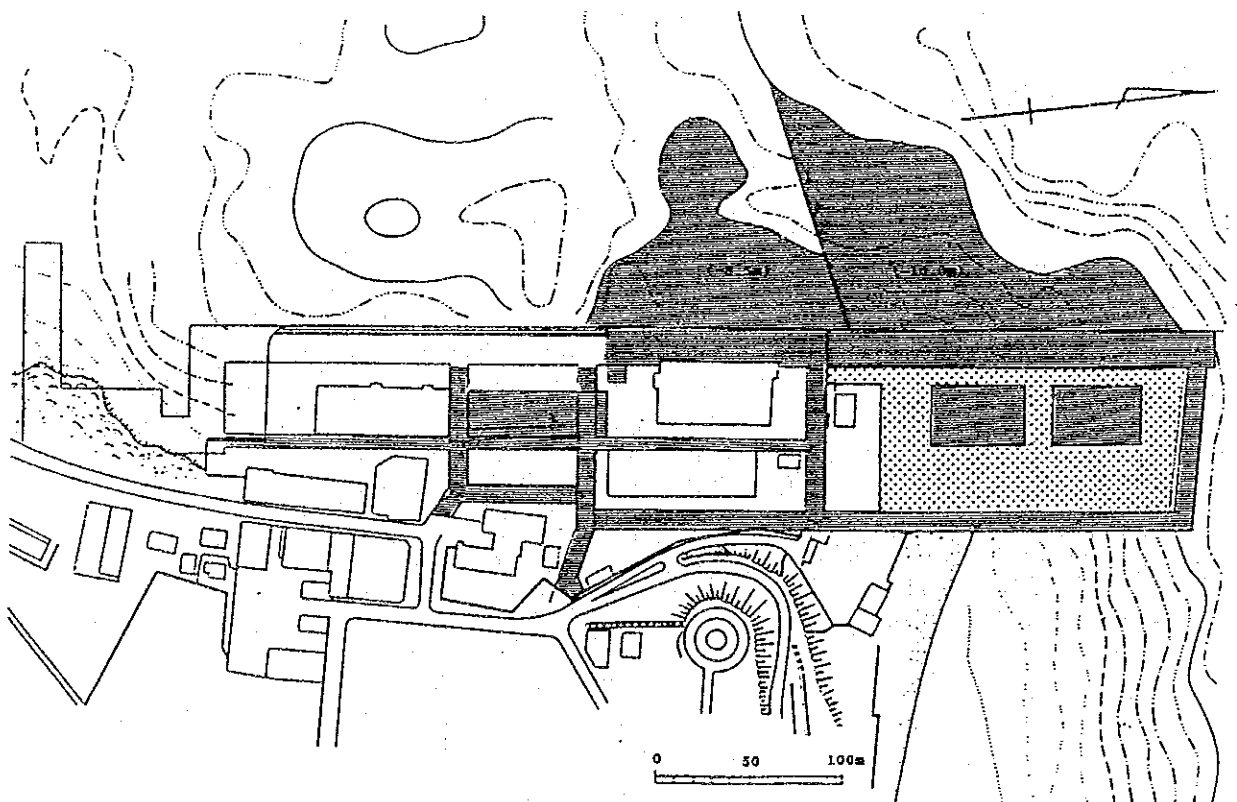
(4) Achèvement des Travaux de Construction en 1998
